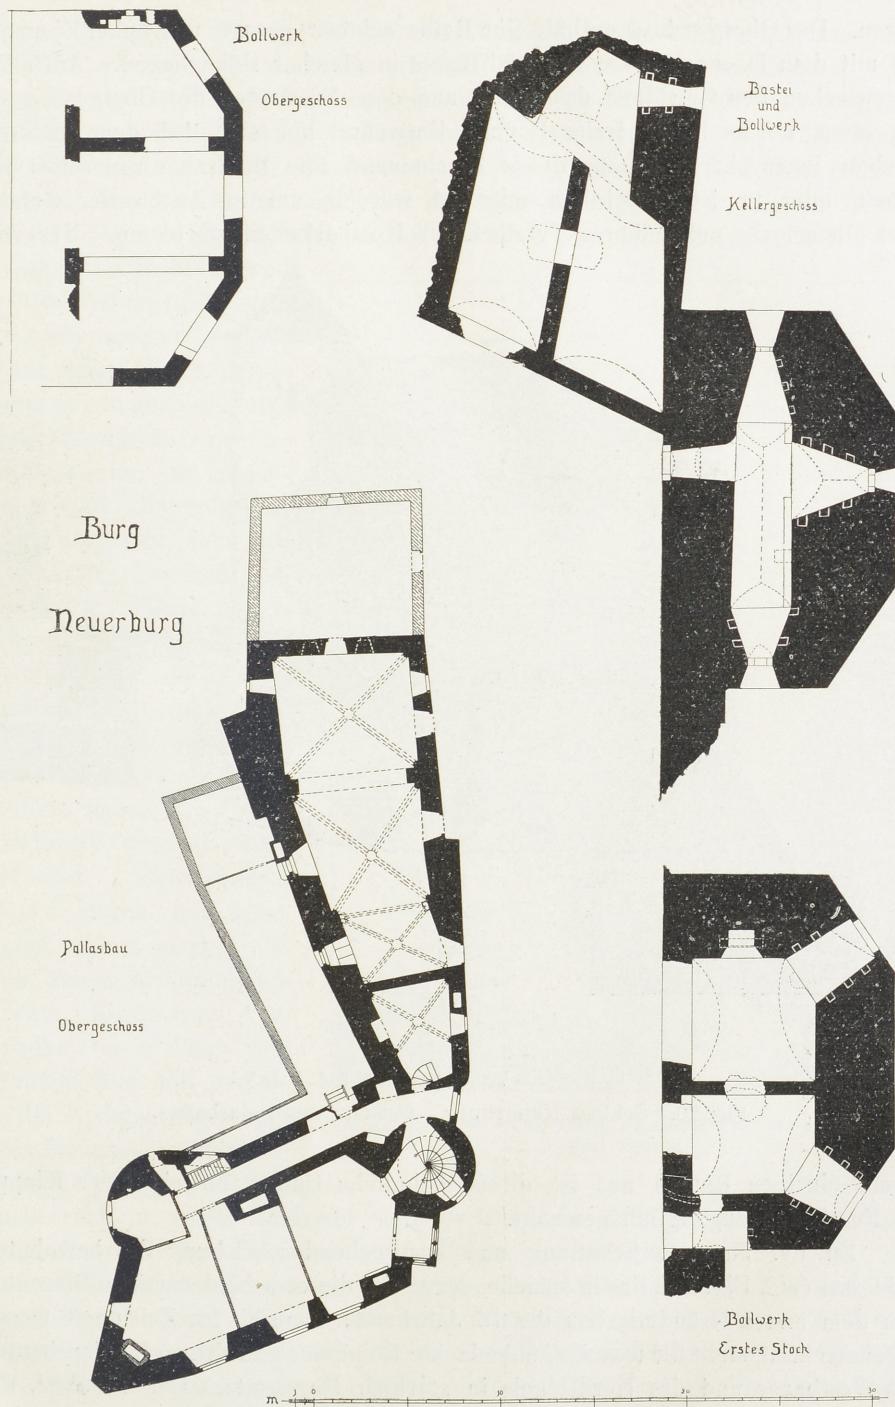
Schloss Neuerburg. Grundriss des Palasbaues; Grundrisse von Bastei und Bollwerk.
